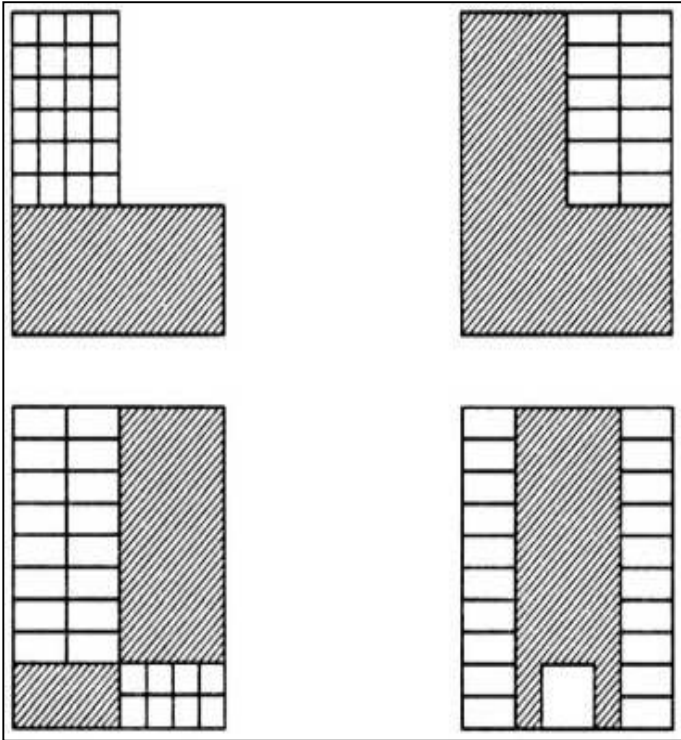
Changement du type de contreventement à l'intérieur d'un même bâtiment changement de type de structure.
